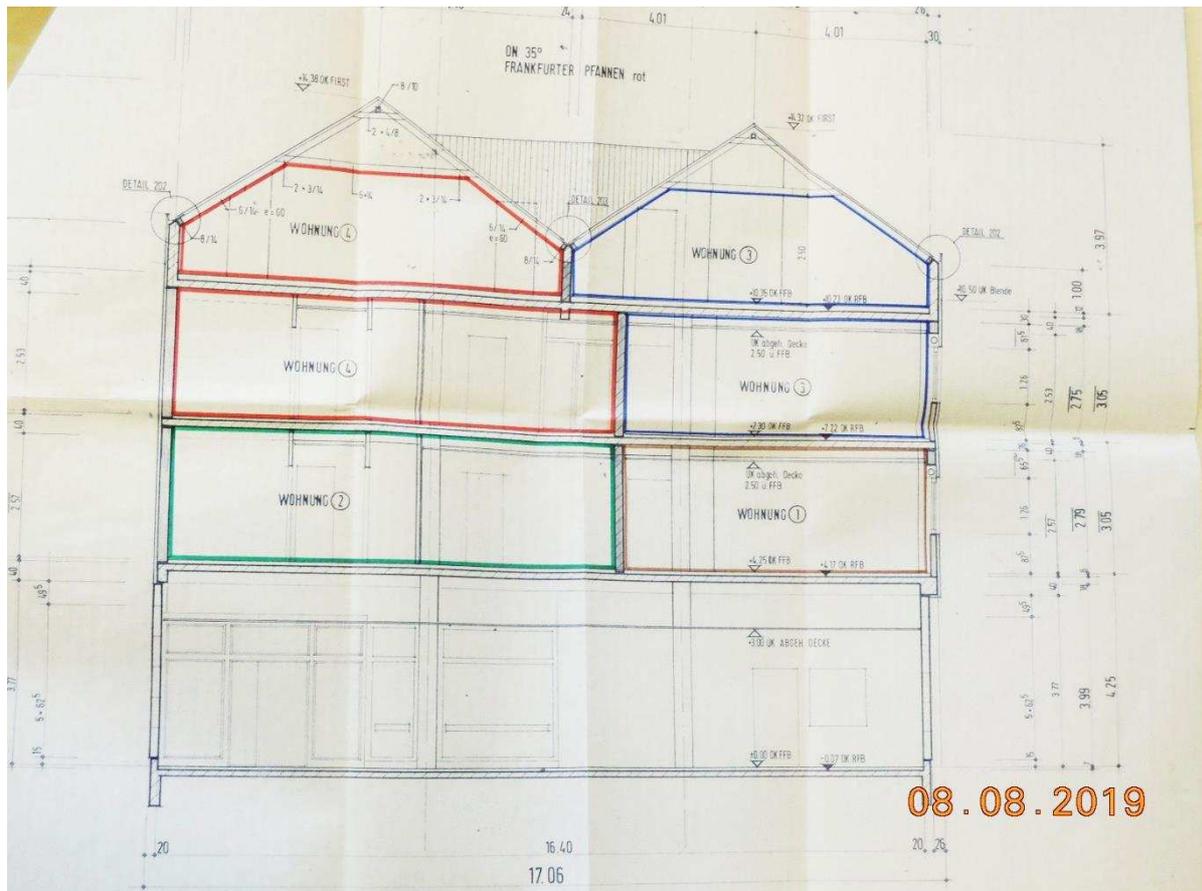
Schnitt straßenseitiger Bereich (nicht maßstabsgetreu, aus Bauakte)
